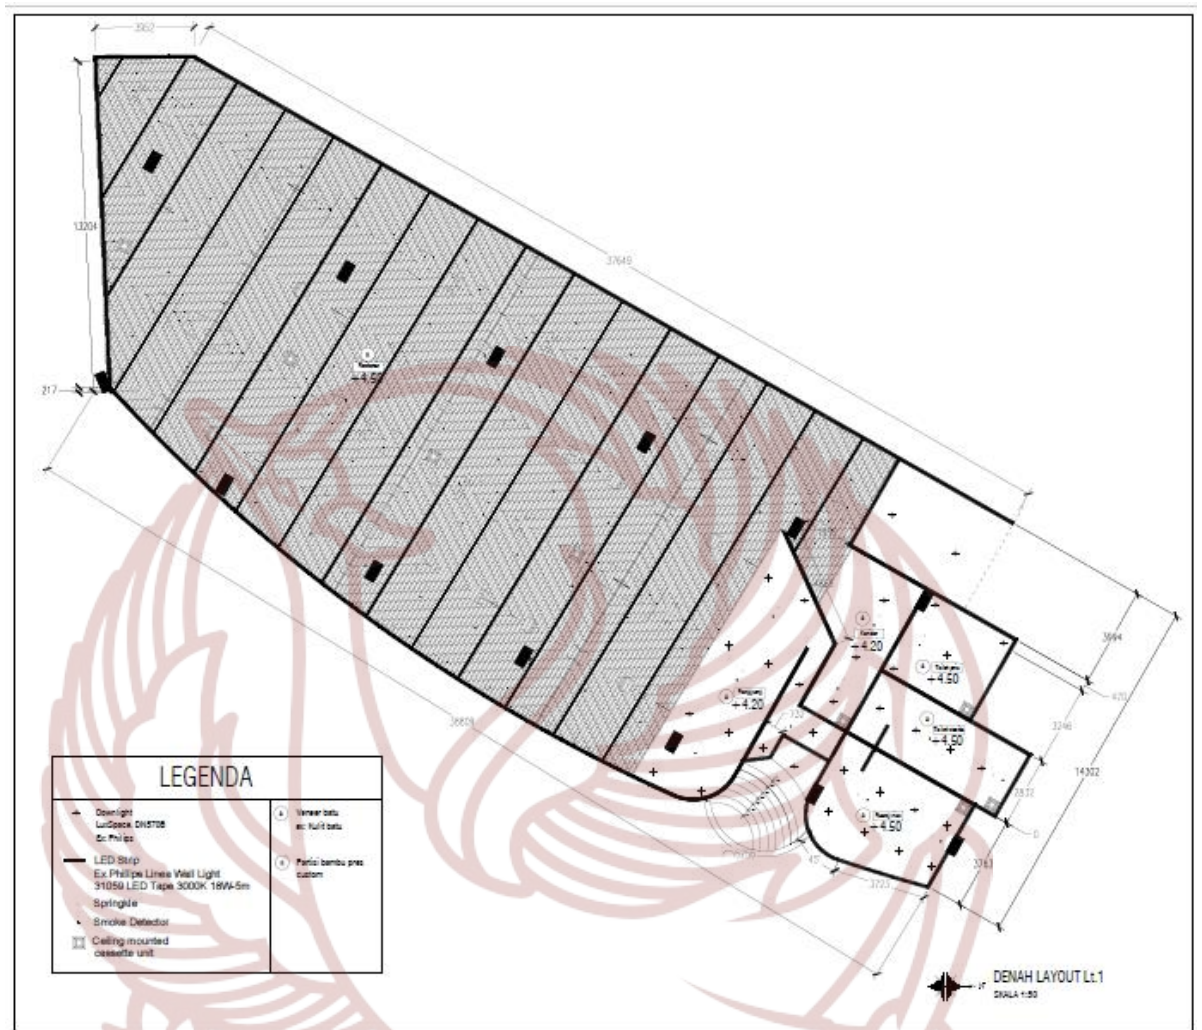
Rencana Lantai *Cottage* tipe 5
